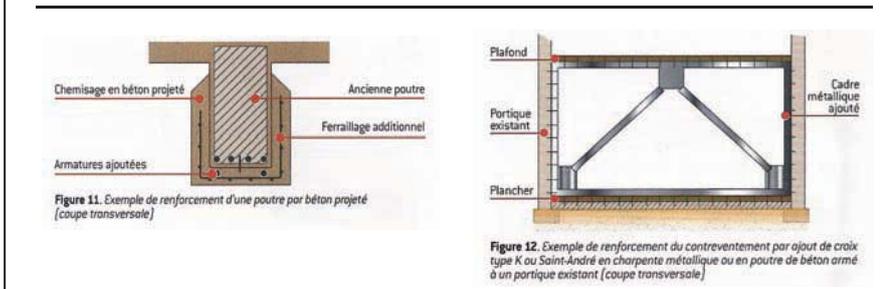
Exemple de renforcement d'une poutre par béton projeté (coupe transversale)
